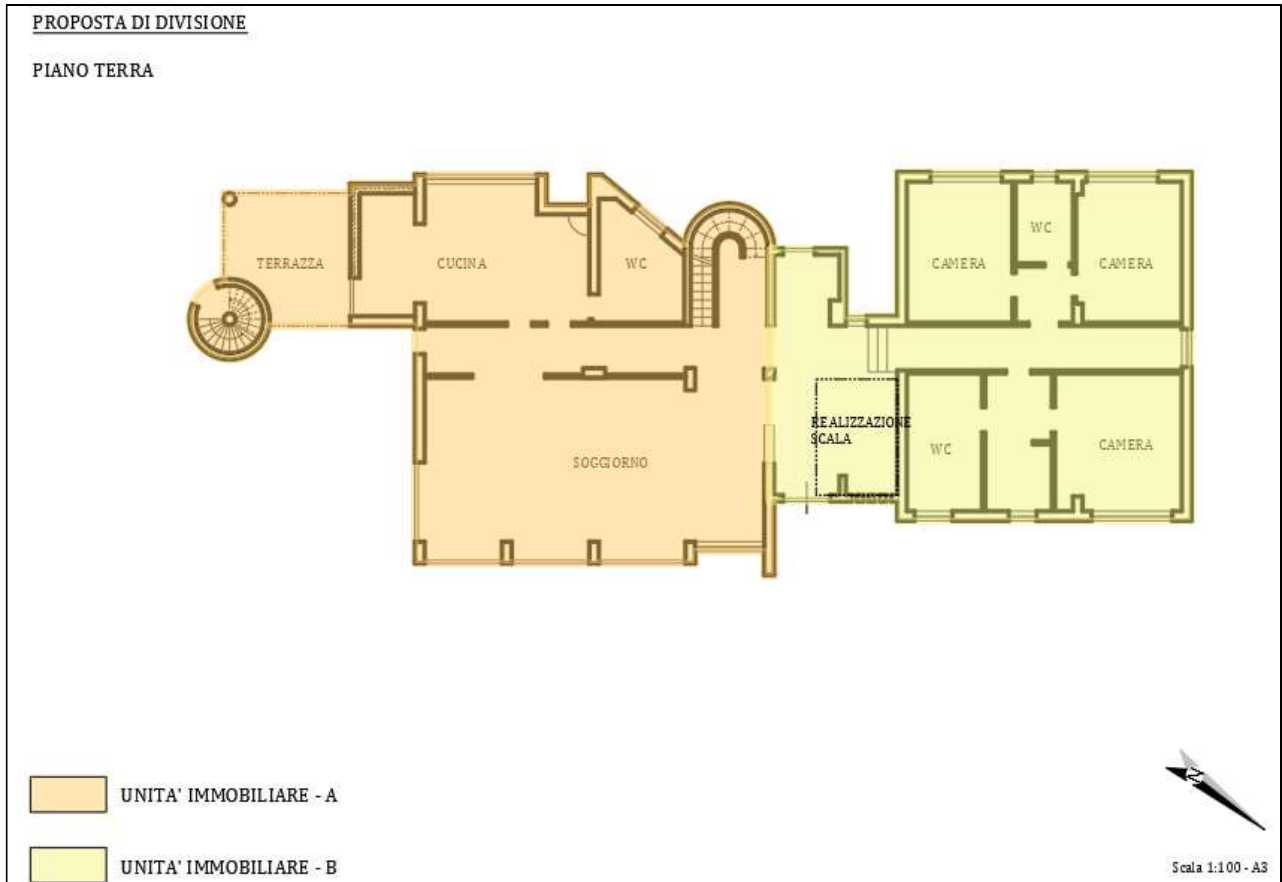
Planimetria dell'immobile PROPOSTA DI DIVISIONE – Piano terra
